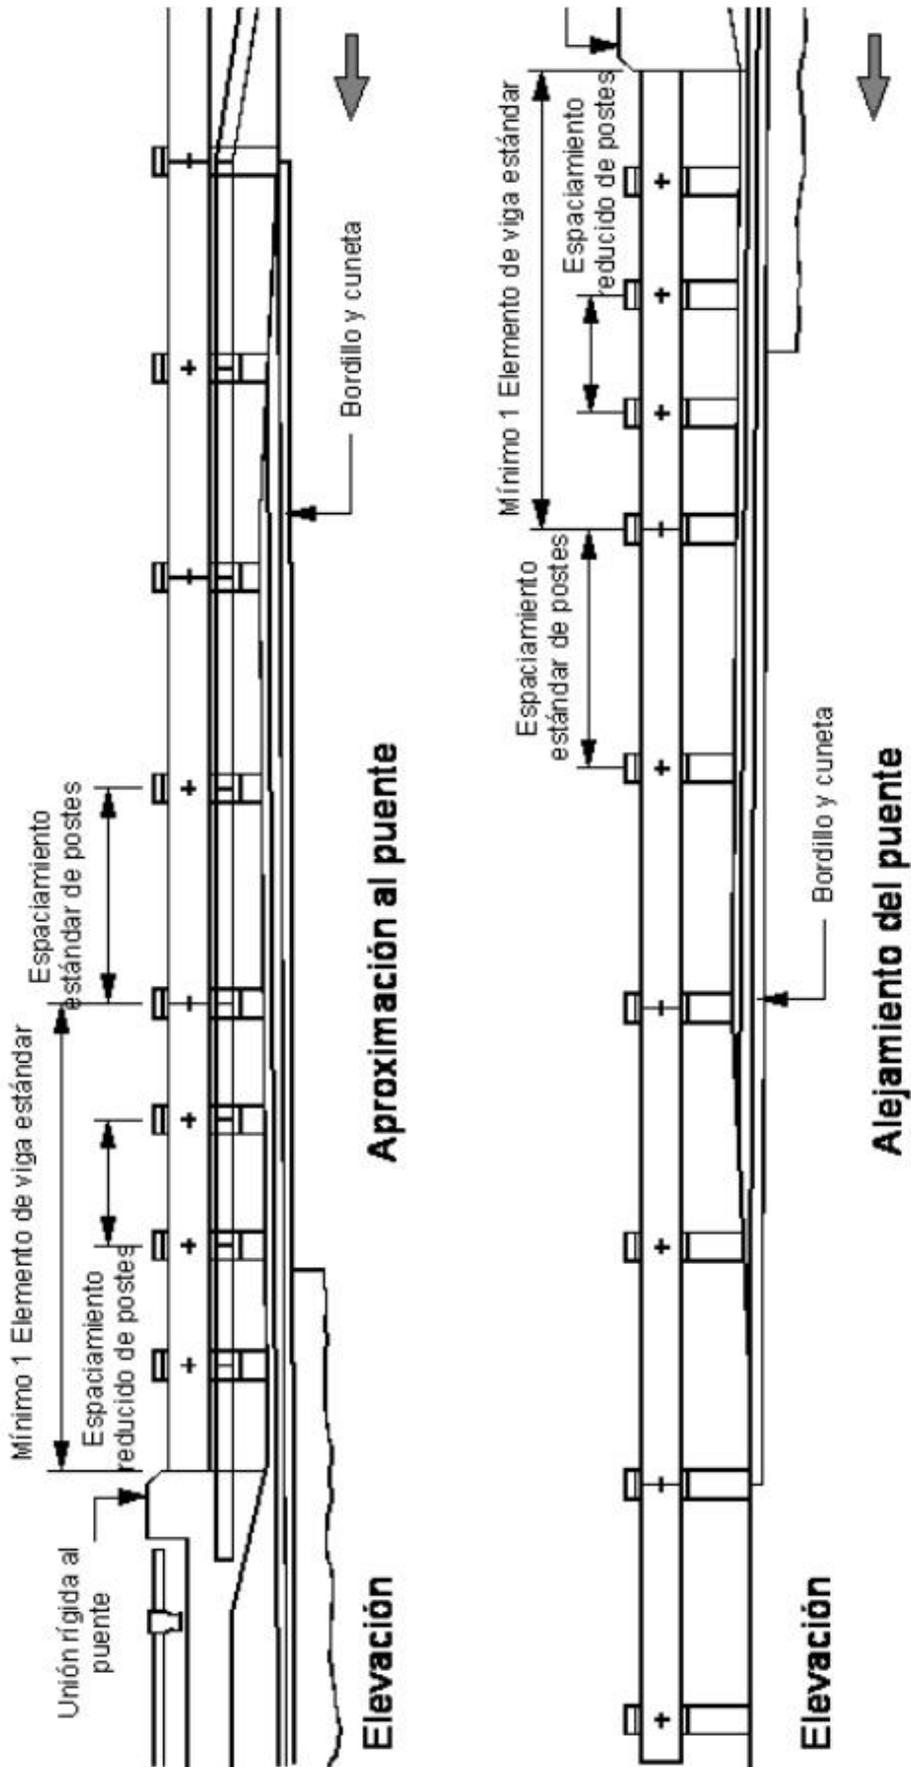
BARRERA DE VIGA DE CAJÓN EN LOS EXTREMOS DE UN PUENTE
